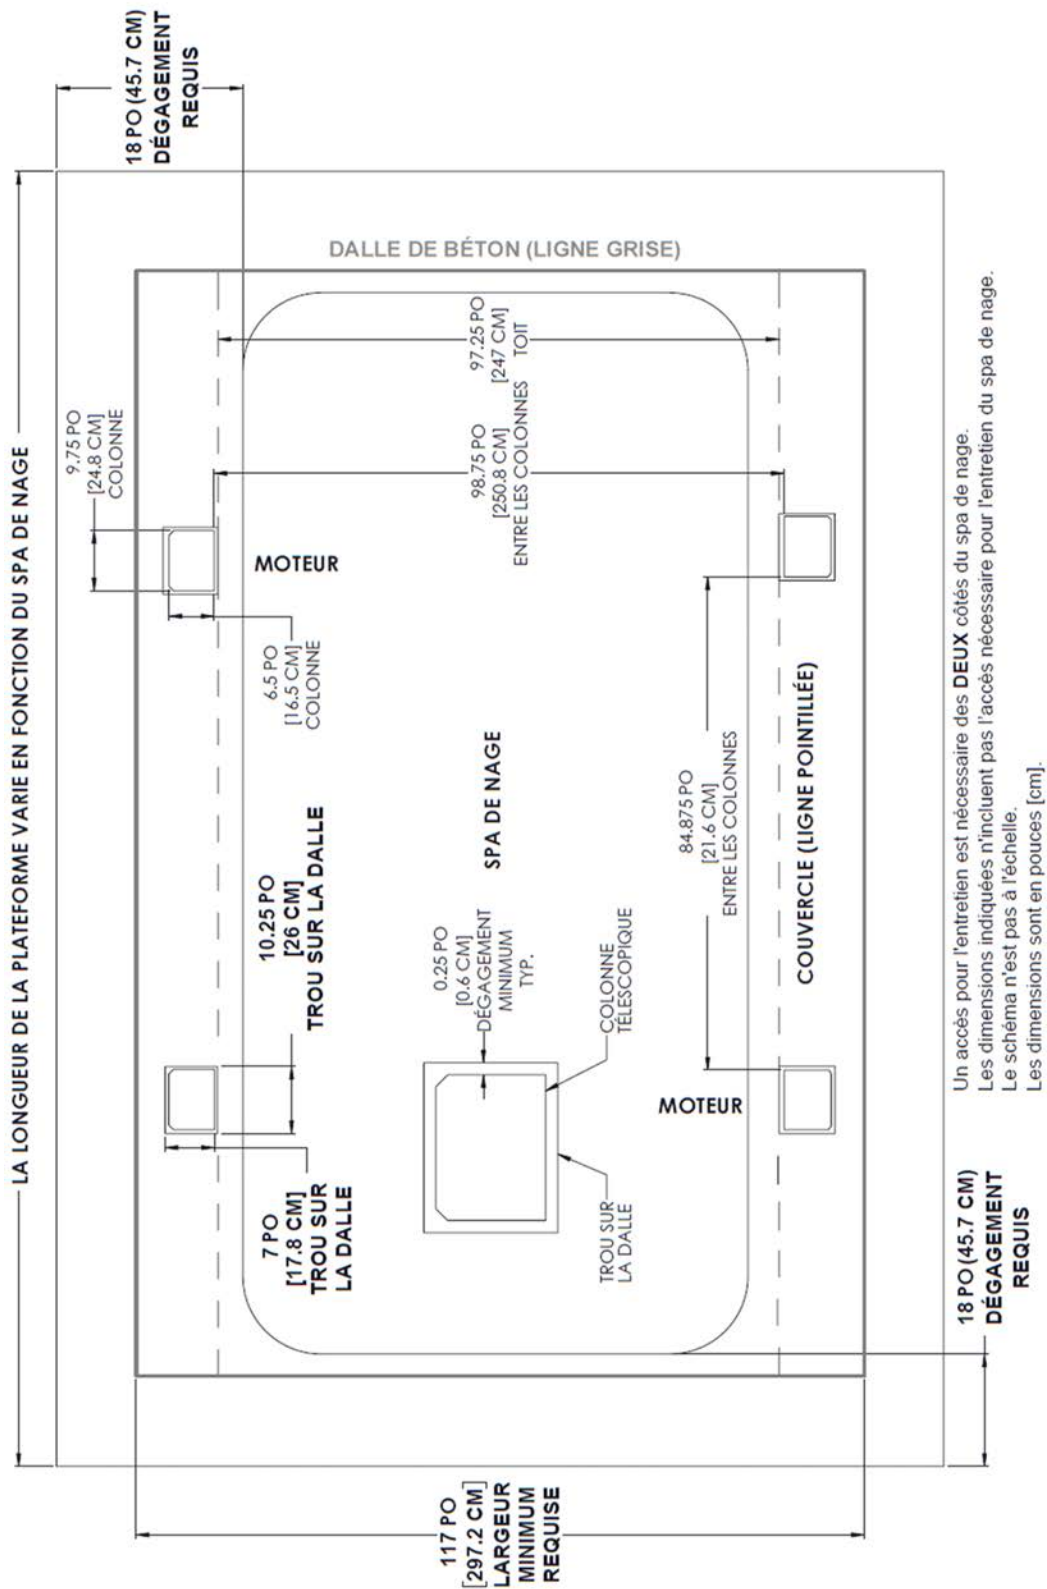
DIMENSIONS DU CADRE ET SUPERFICIE
